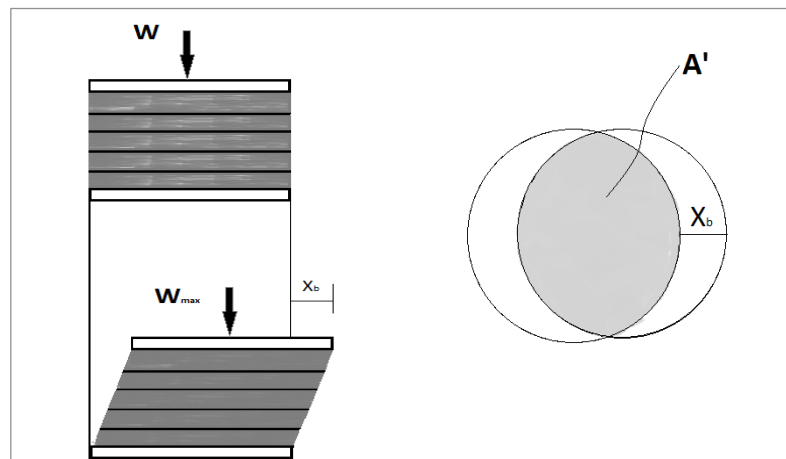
c. Zona de superposición entre la zona fija y la zona desplazada una distancia X_b del aislador.
